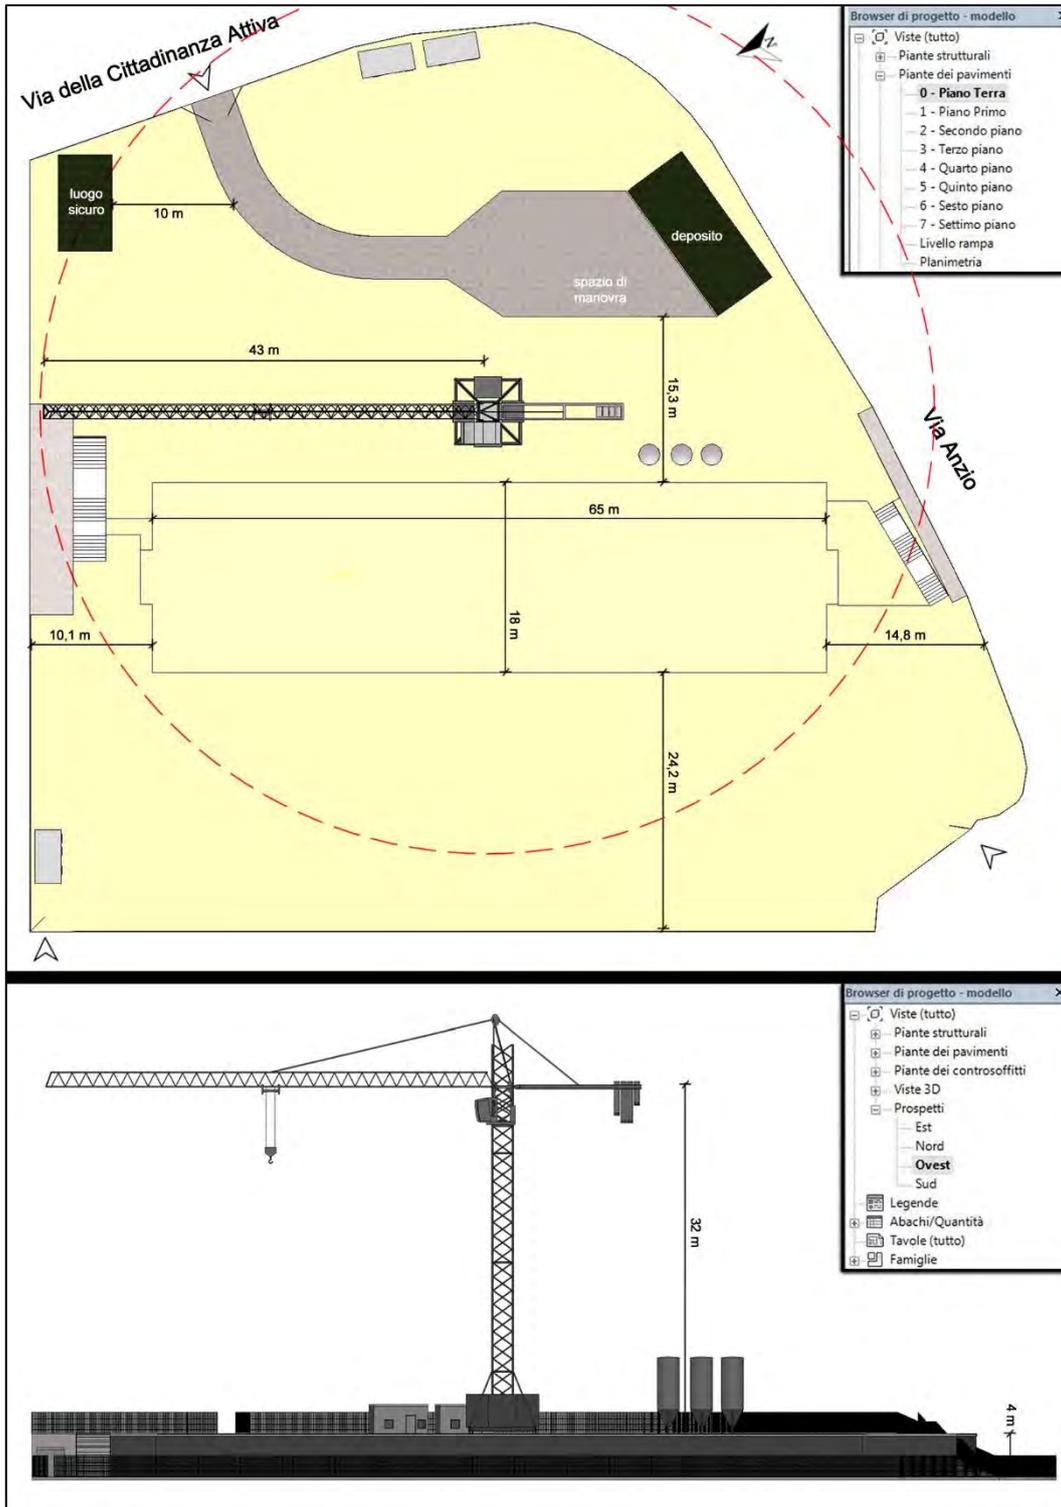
Planimetria e prospetto della fase di allestimento del cantiere
